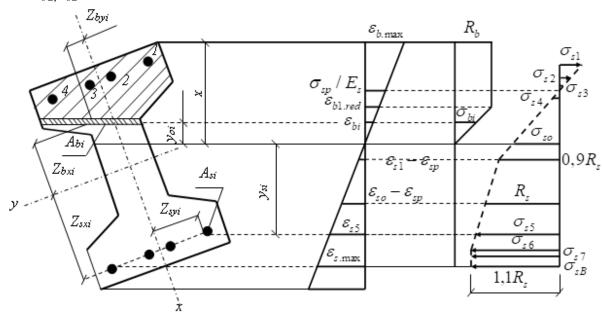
Эпюры деформаций и напряжений бетона и арматуры a - эпюра деформаций; б — эпюра напряжений бетона; в - напряжения в стержнях напрягаемой арматуры c условным пределом текучести
